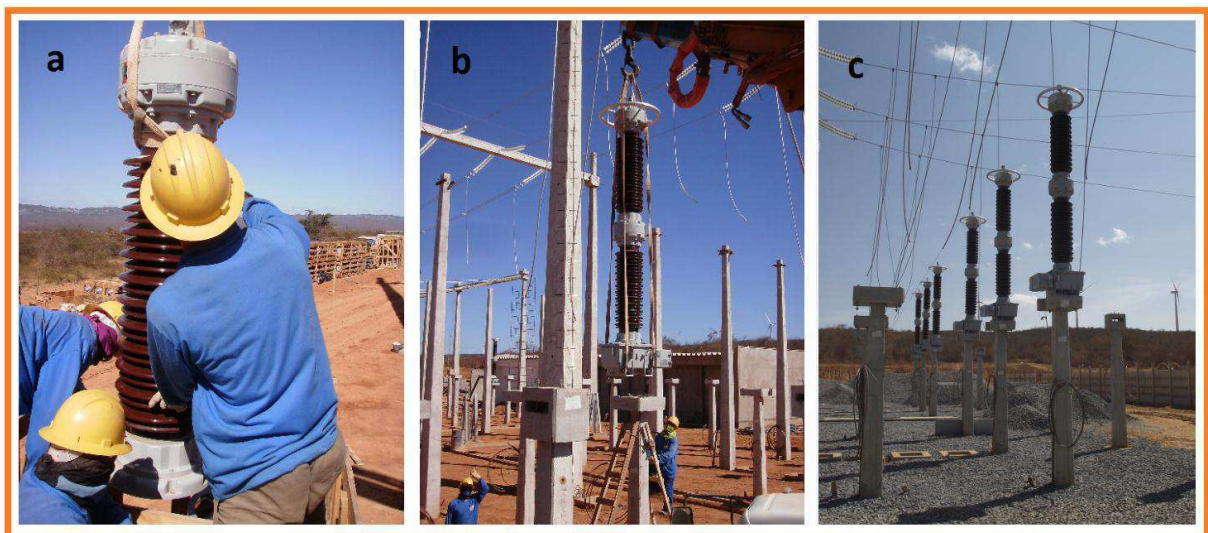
Montagem do TPC: (a) montagem dos módulos (b) fixação (c) montagem acabada
